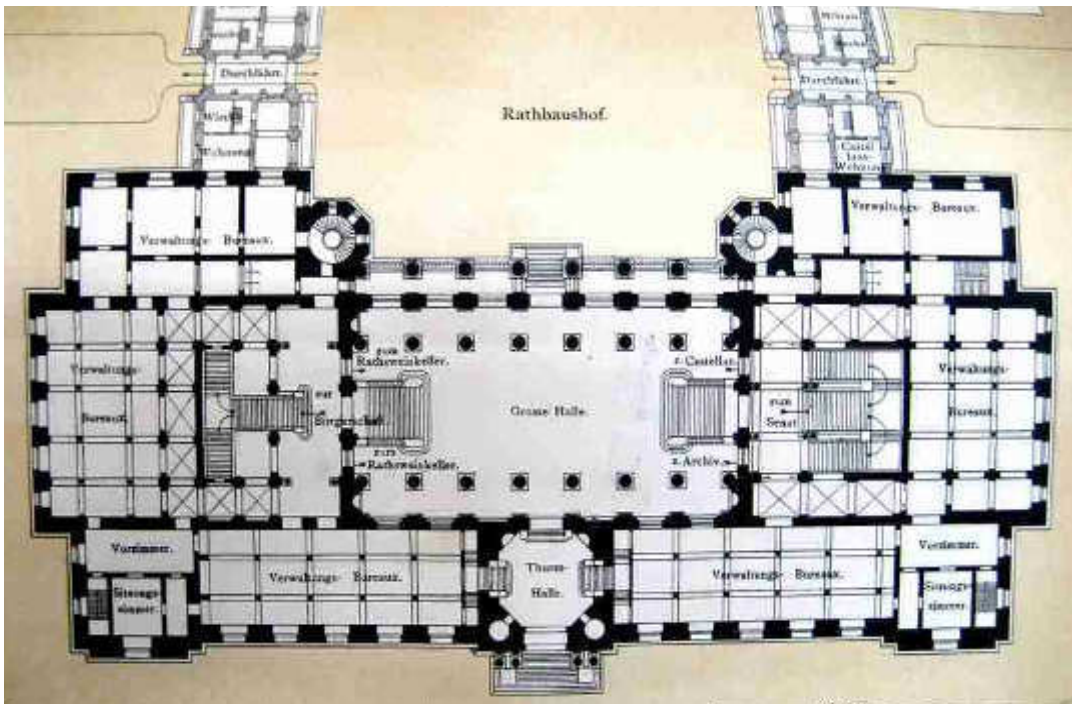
Grundriss Erdgeschoss Entwurf Viribus unitis 1880.
